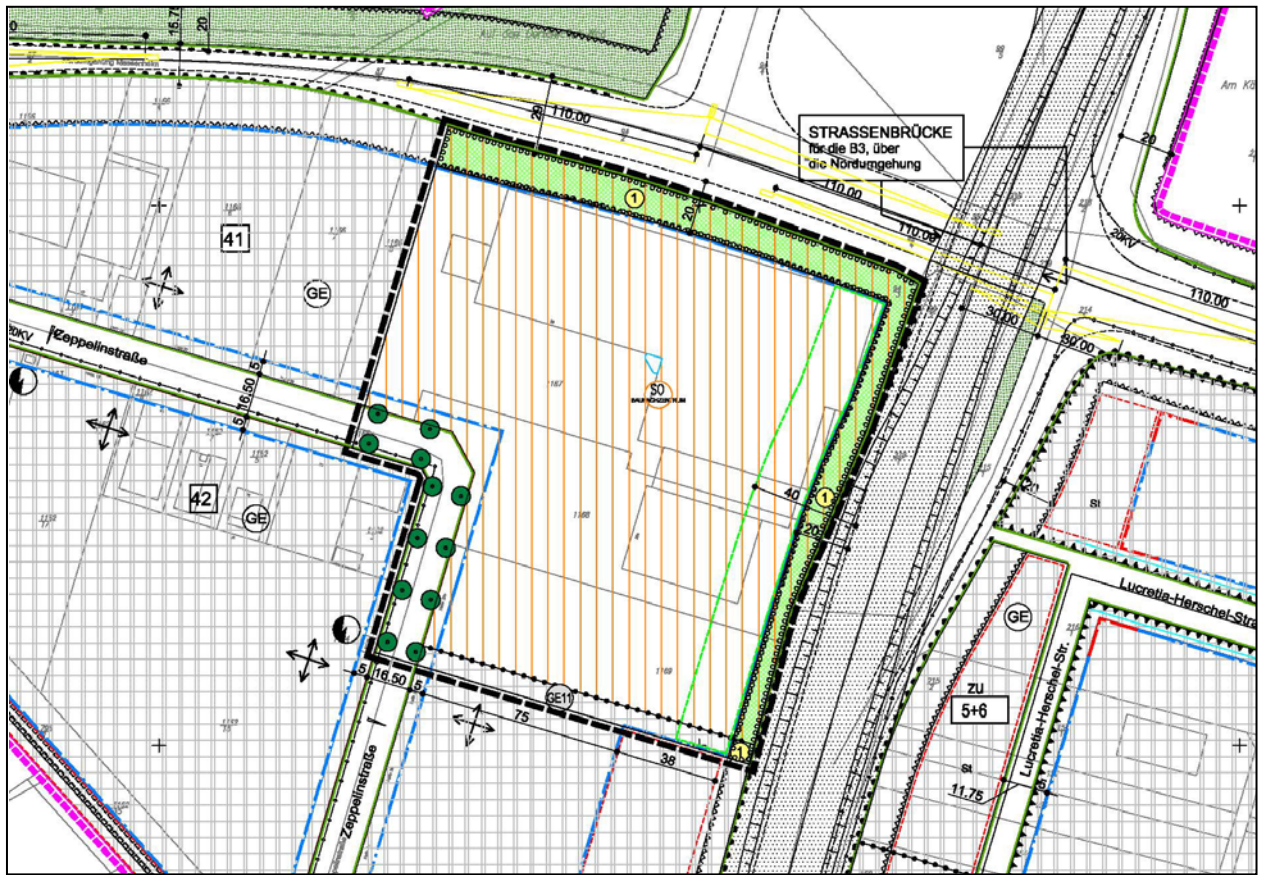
Bebauungsplan „5. Änderung Krebschere“
